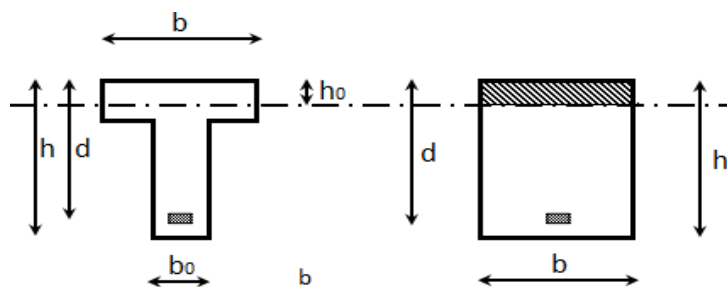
Coupe de Section Rectangulaire et Section en T.
